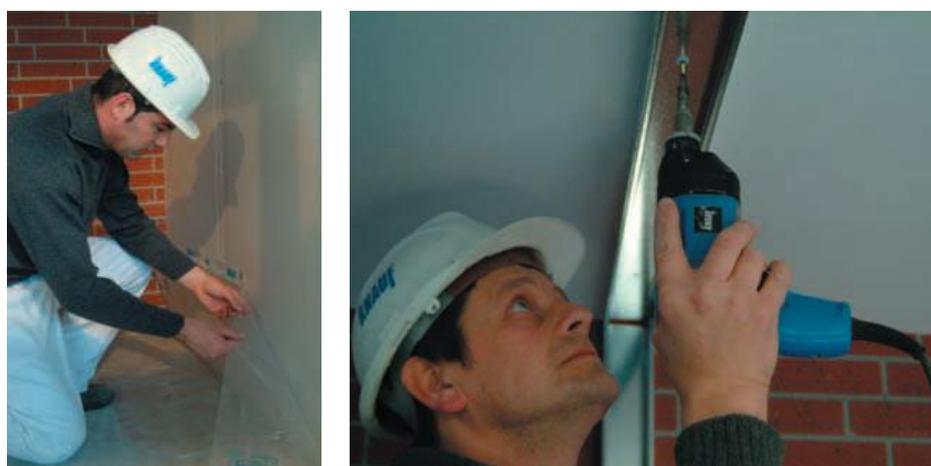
predisposizione di un foglio in polietilene sotto la guida e fissaggio della guida superiore.
